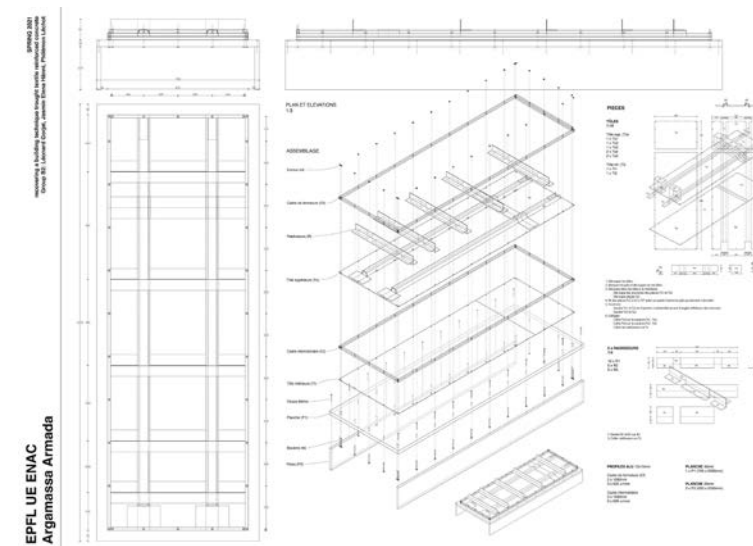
| Dibujos de los encofrados para la construcción de forjados en HT. Fuente: Patricia Guaita y Raffael Baur.
